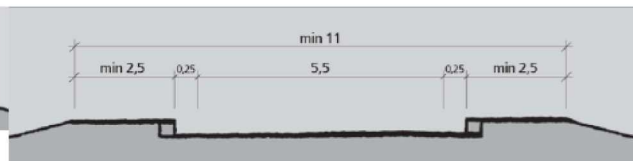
Dimensjoneringsklasse Sa2 med 2-sidig fortau
